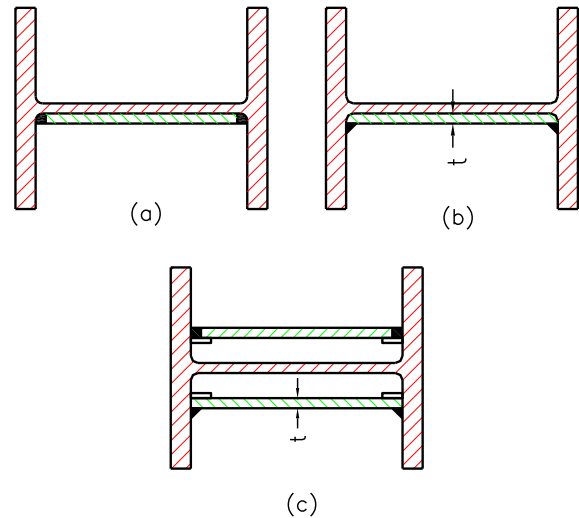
Placas nodales de refuerzo con soldadura de penetración completa o soldadura de filete.
